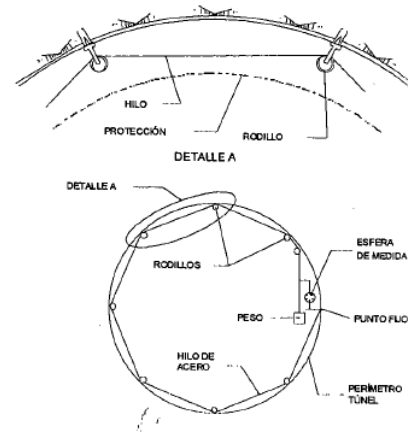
Configuración de dispositivos para medidas perimetrales.
